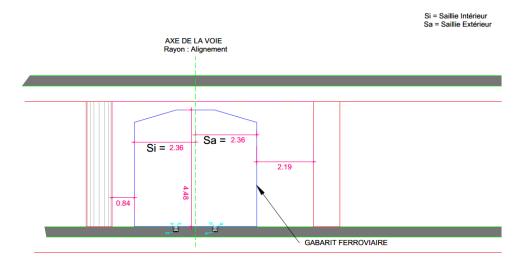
Coupe-type voie béton dans le bâtiment (source : ARTELIA)
